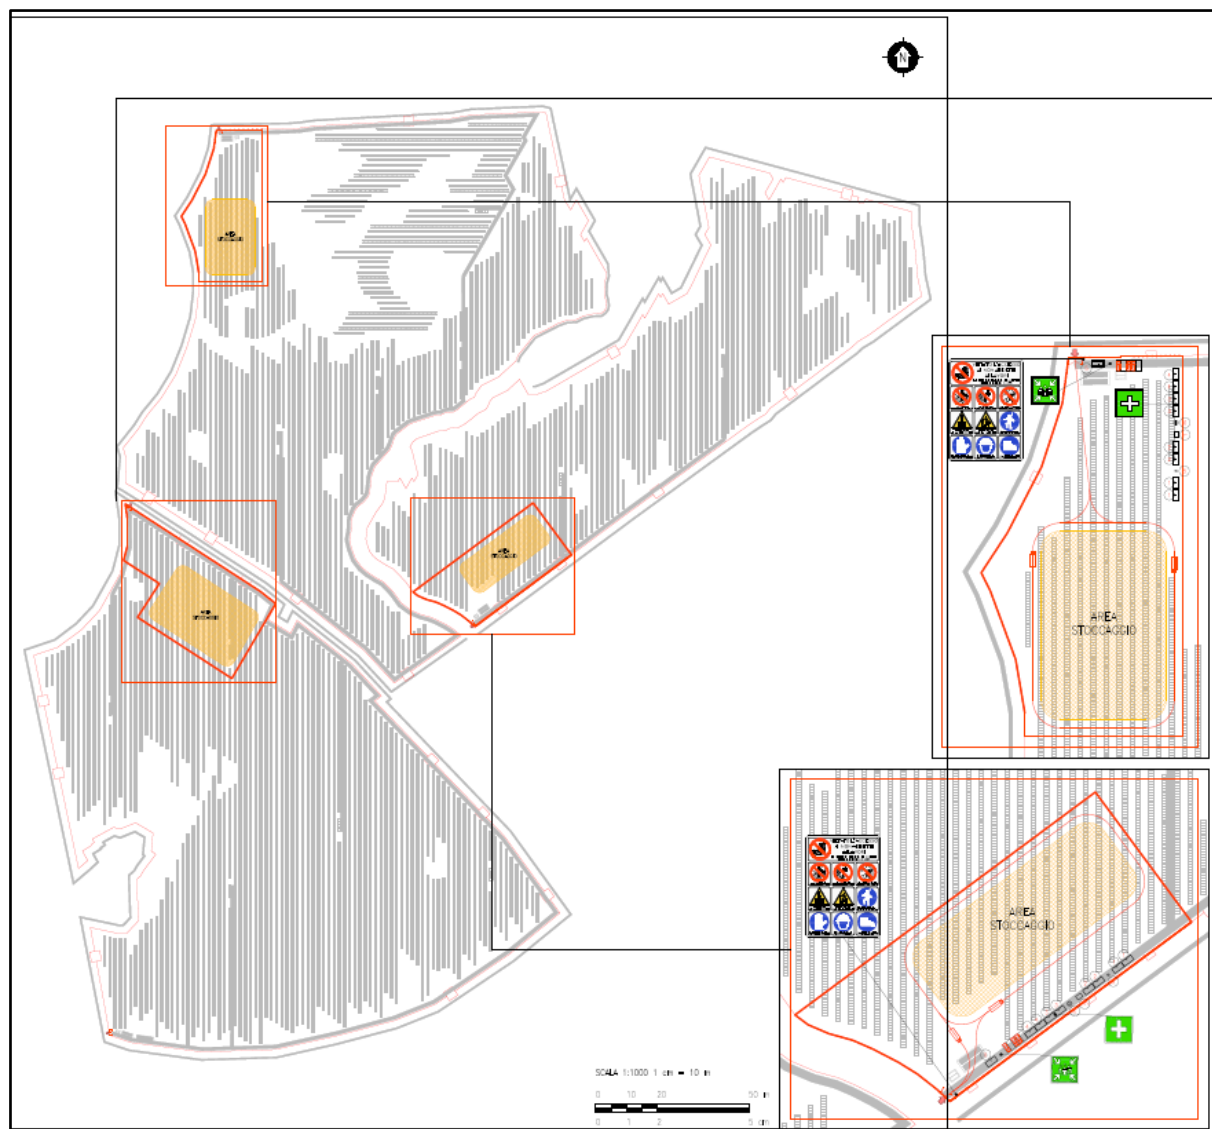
Aree di Cantiere previste all'interno dell'Area di Impianto- rif. Elaborato 2983_5211_RE_VIA_T08_Rev0_Planimetria area di cantiere
